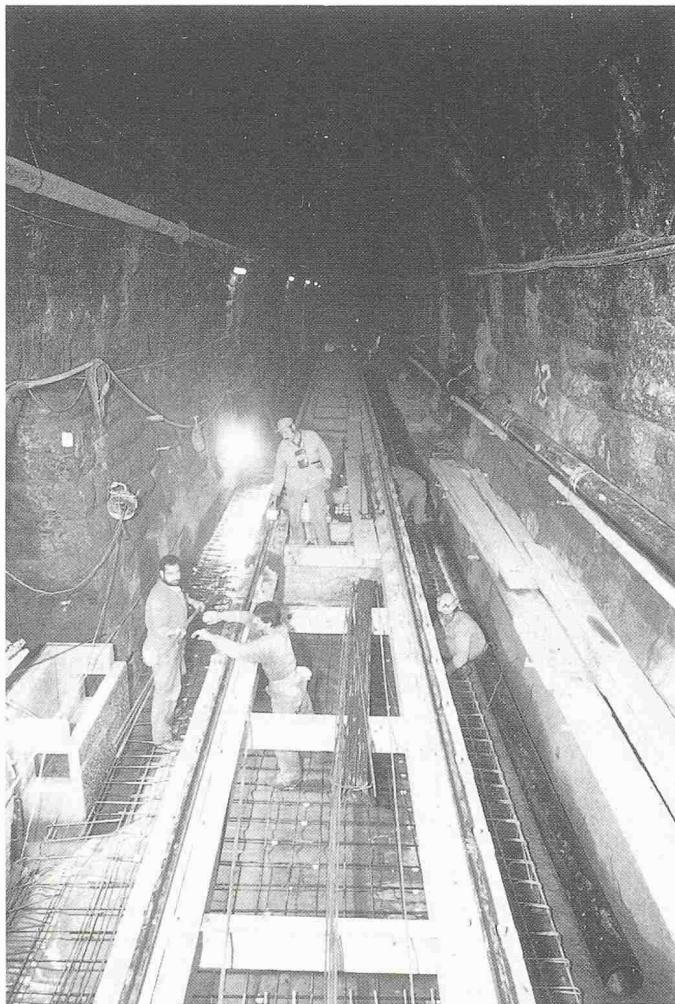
Zuspritzen einer Widerlagerunterfangung mit Spritzbeton
